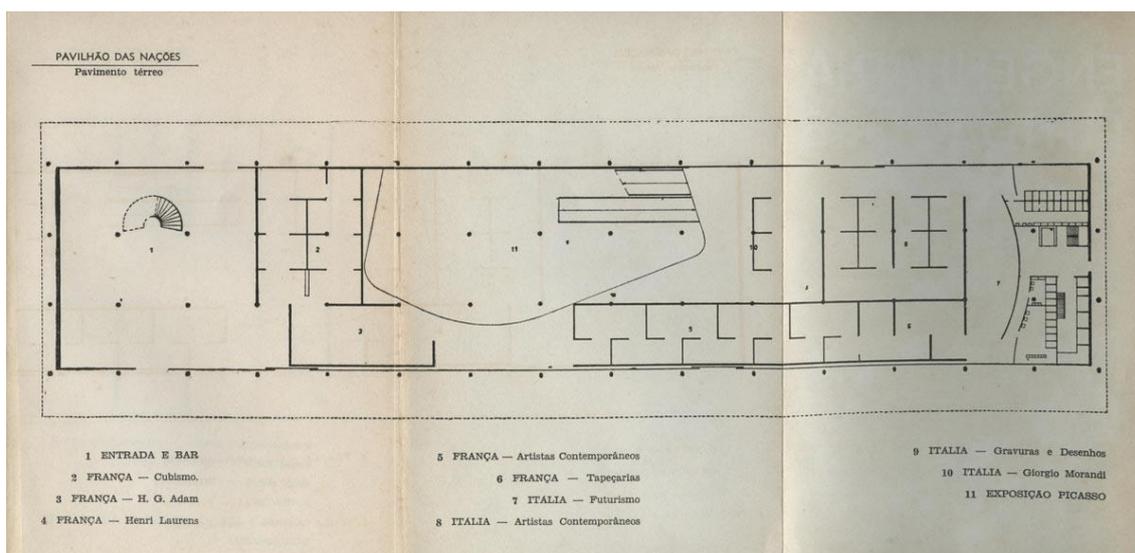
Planta de layout do pavimento térreo do Pavilhão das Nações na II Bienal de São Paulo. Fonte: Bienal
